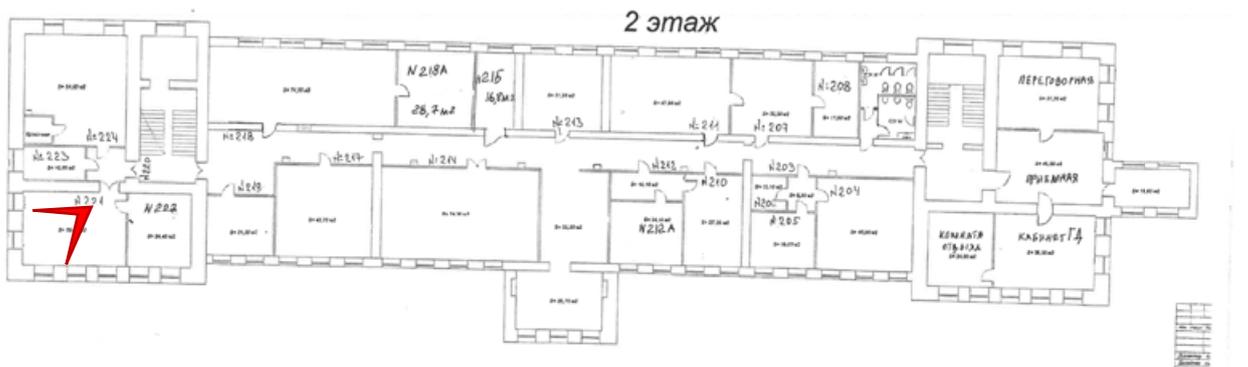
2 этаж. Помещение 4-Н(2,3).
